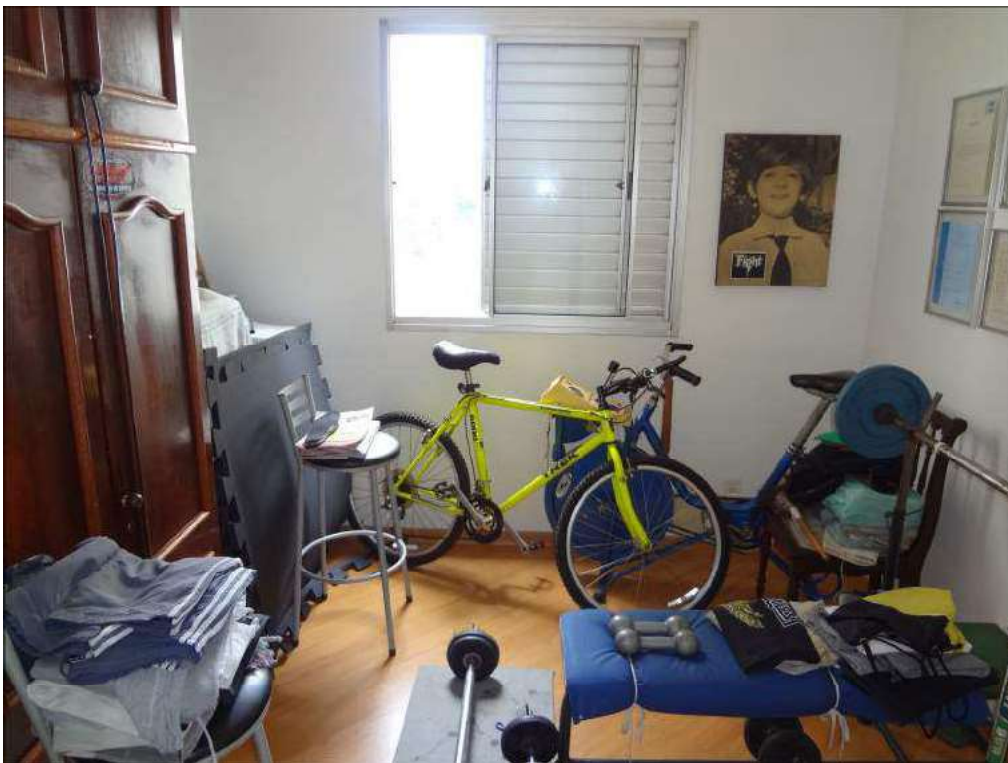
Dormitório 2, destaque para a esquadria em alumínio e o piso laminado.
